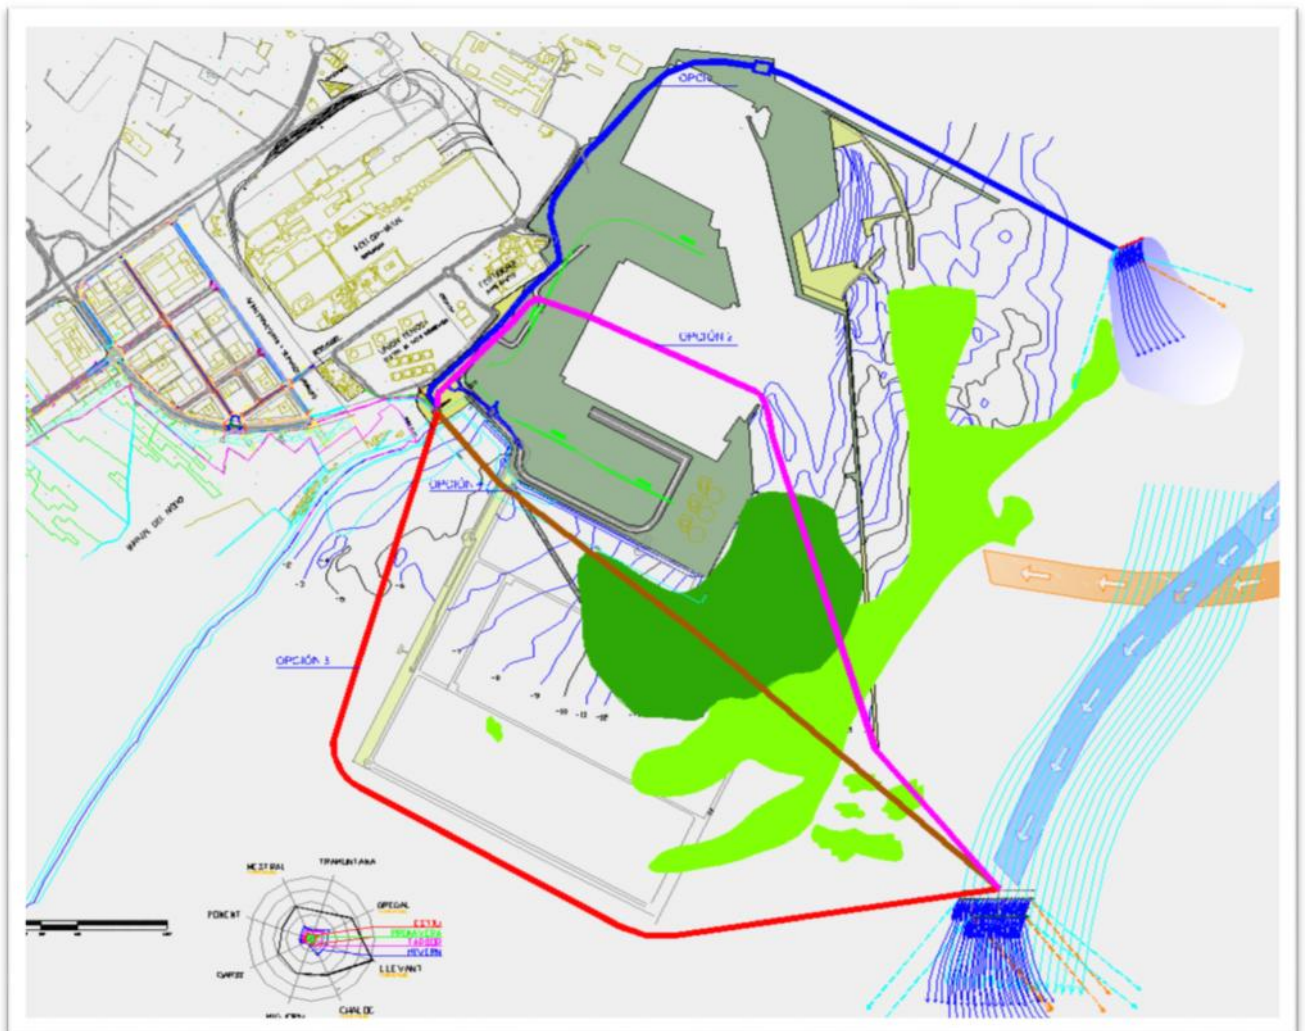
A Plano nº 4 Trazado propuesto para cada alternativa
